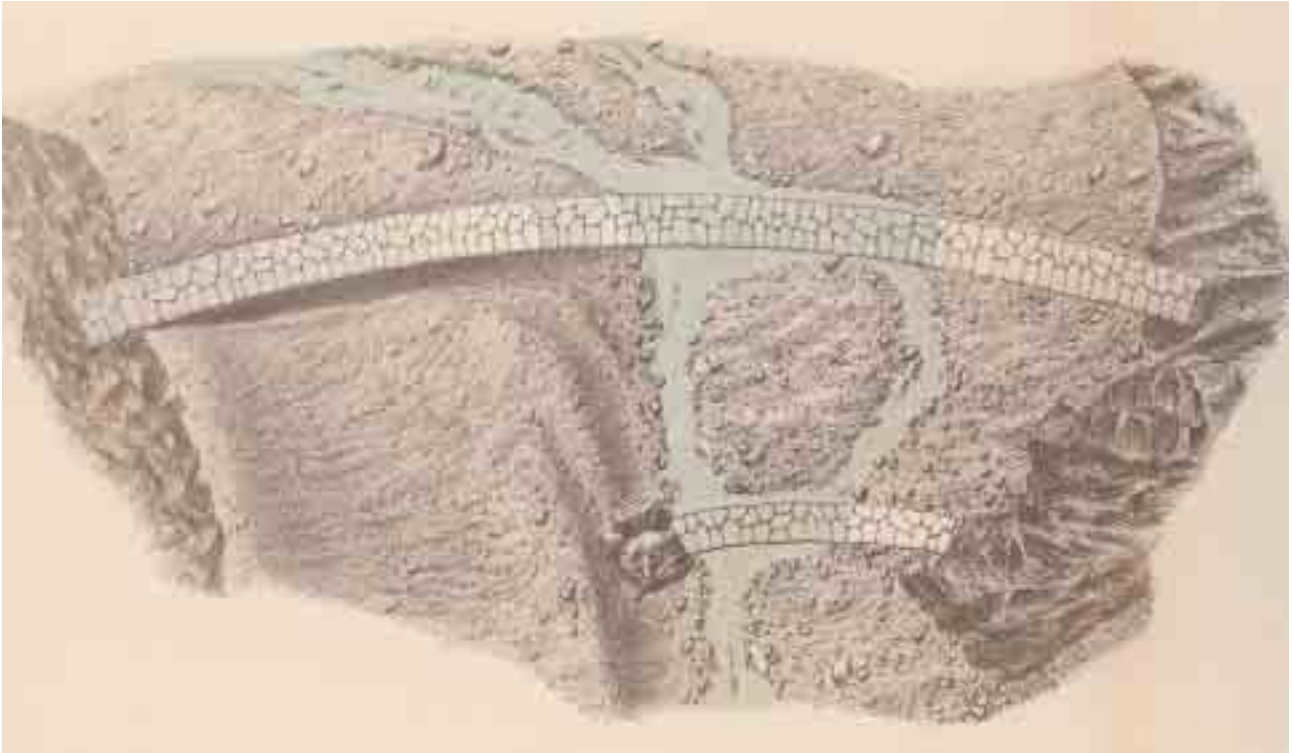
Grundriss der Sperre I an der Nolla.
